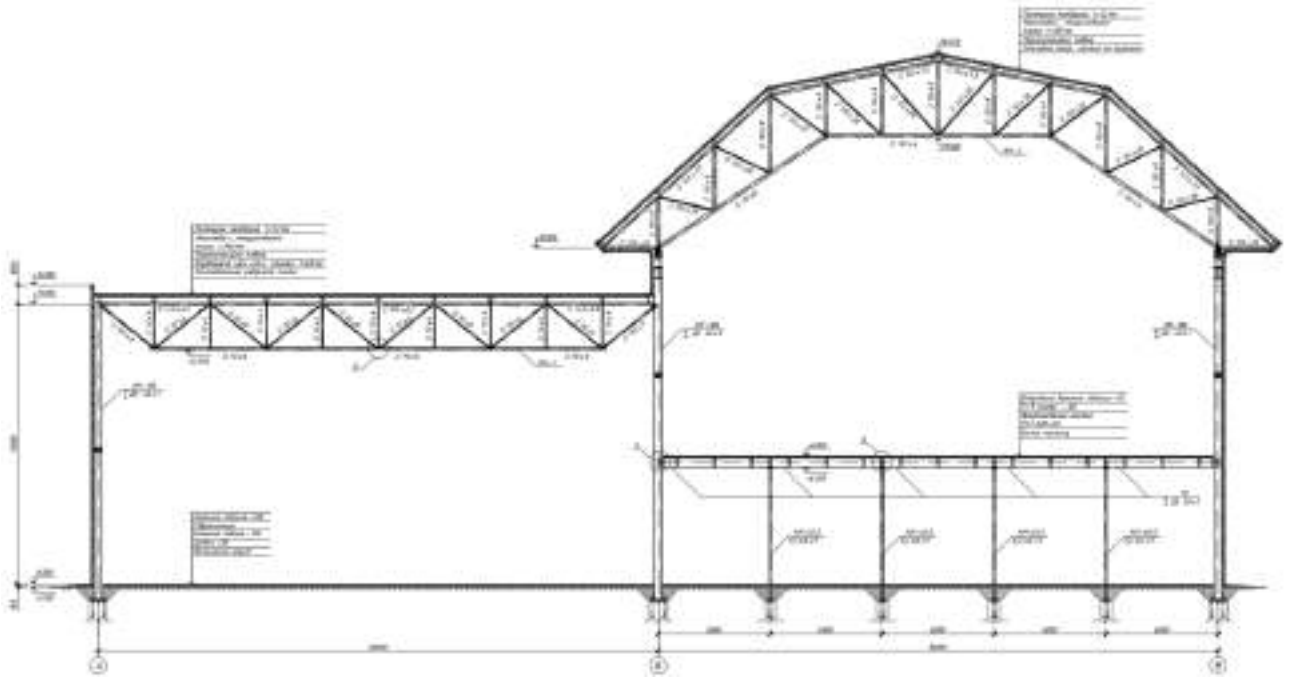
Схеми конструкцій на поперечному розрізі
